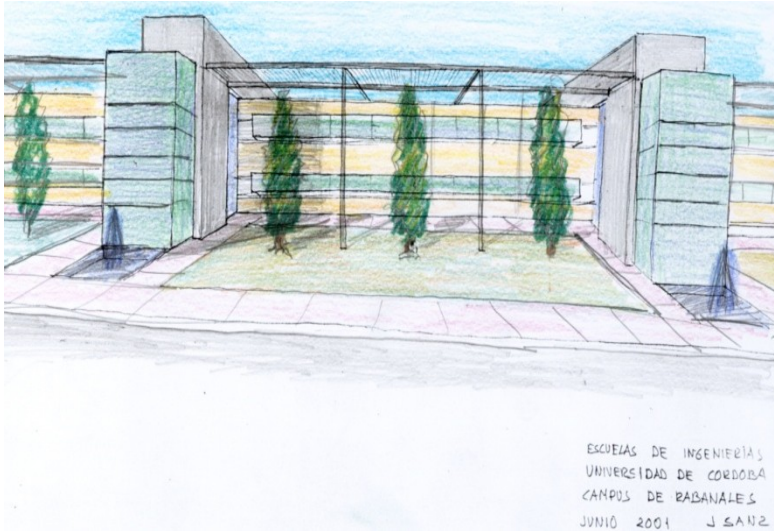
croquis del autor en la fase de la intención y evolución analítica en la proyección arquitectónica de la fachada Sur en Leonardo da Vinci
